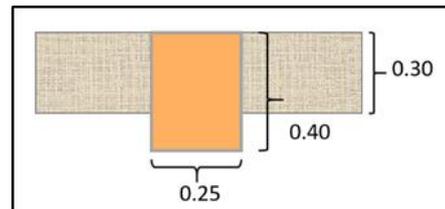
Sección de vigas. Fuente: Elaboración Propia
